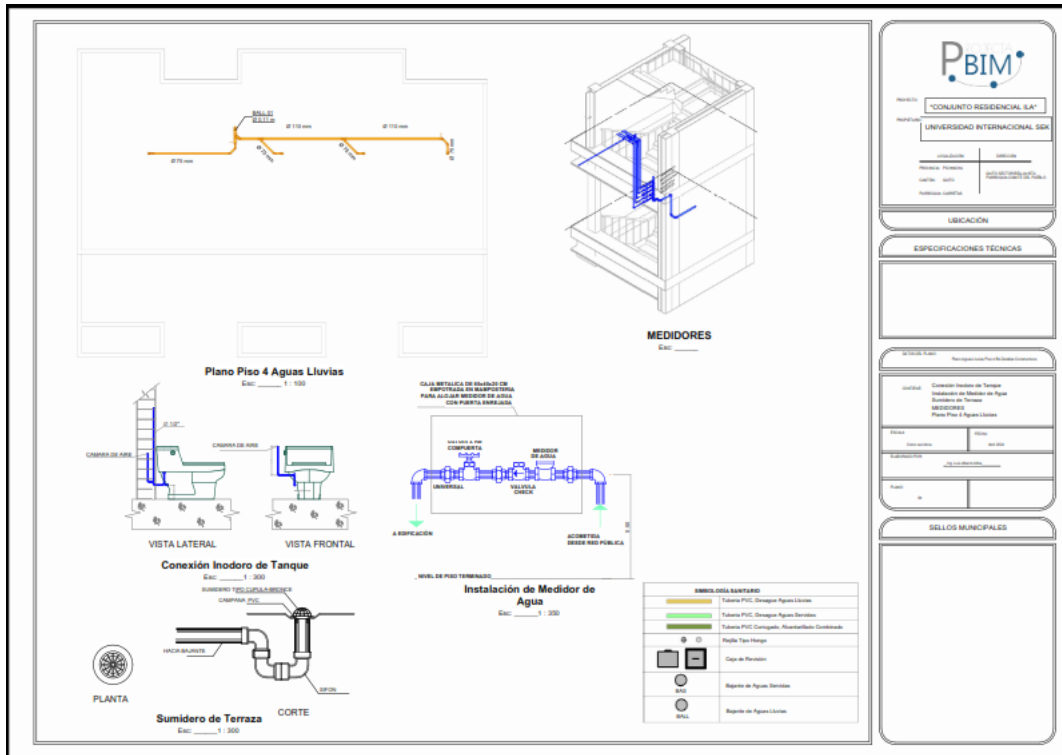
Plano Aguas Lluvias - Detalles Constructivos B4
